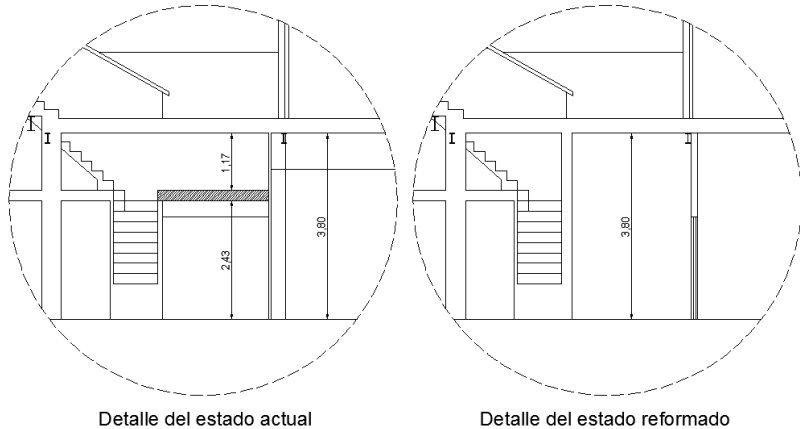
Detalle del derribo del techo del baño y de la despensa de la vivienda de la planta baja. 2014. Elaboración propia.
